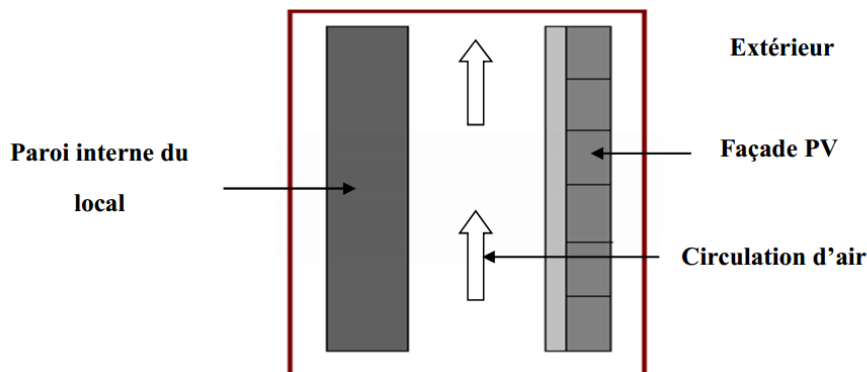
Coupe de la lame d'air en sous-face des panneaux PV.
